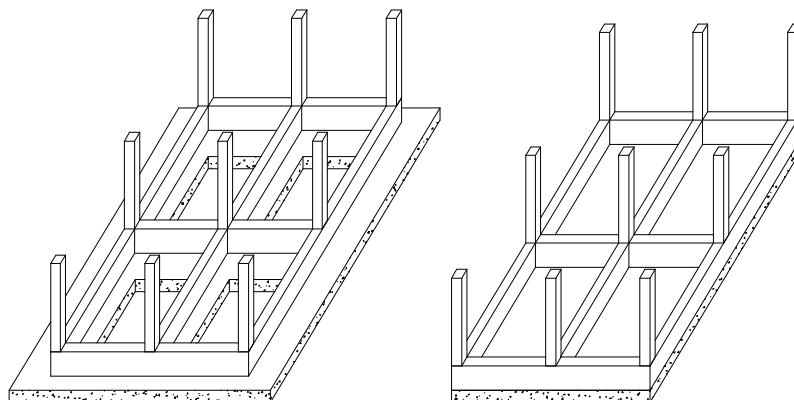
RETÍCULAS DE CIMENTACIÓN CON ZAPATAS CORRIDAS Y CON LOSA BASE Y CONTRATRABES RESPECTIVAMENTE
